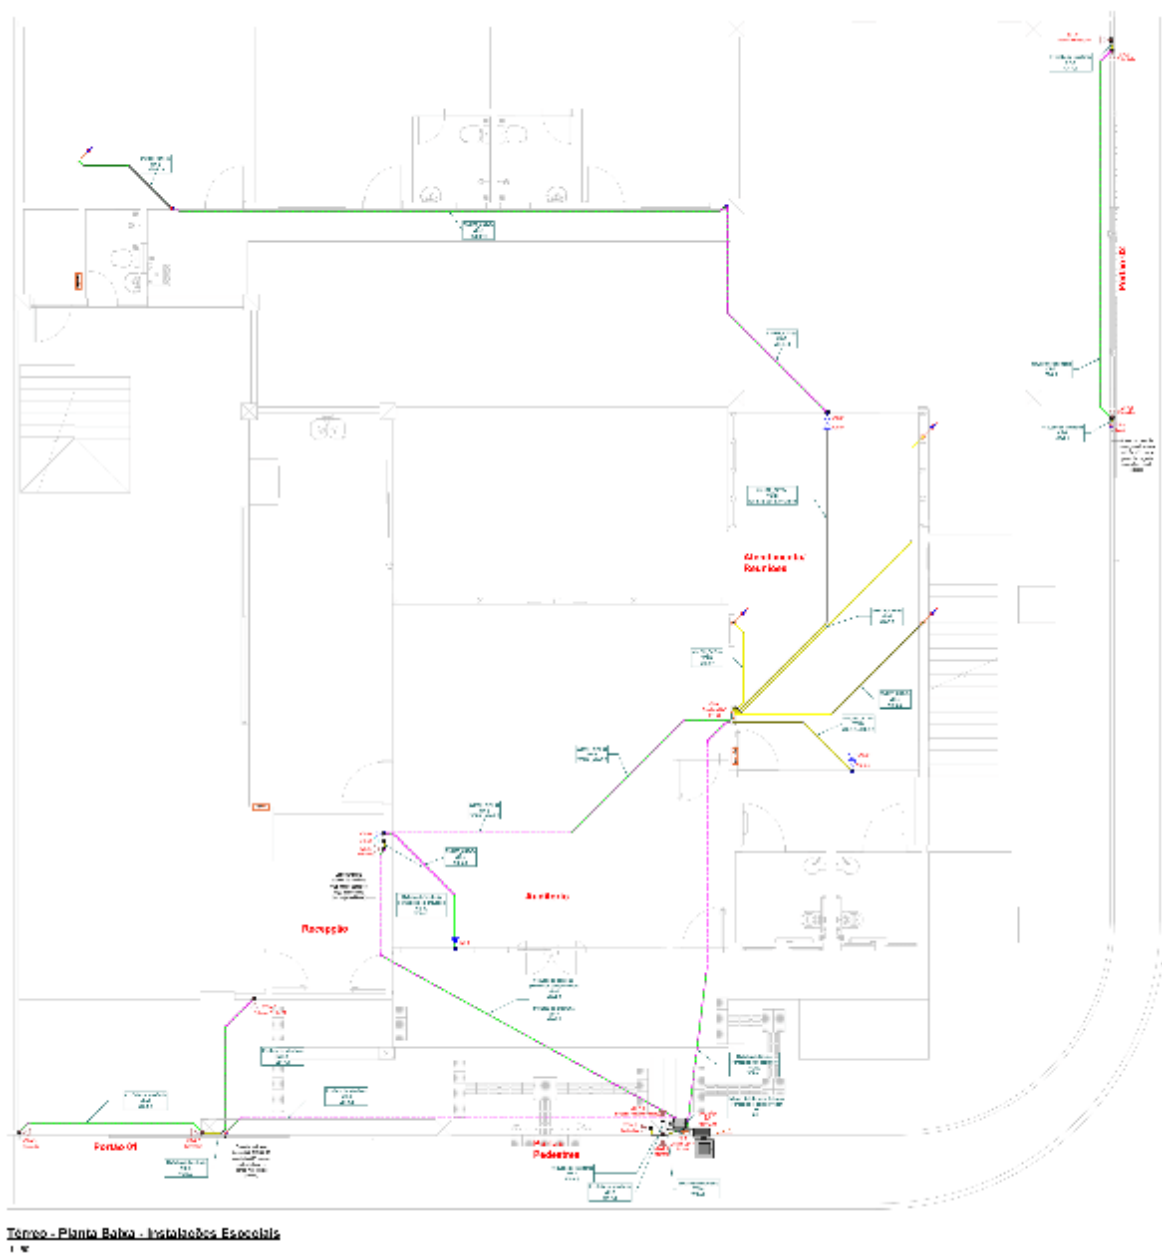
Planta baixa do Projeto de Instalações Especiais.
